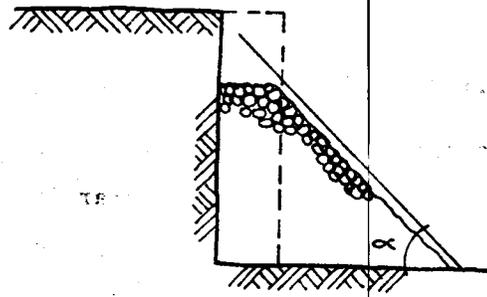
El ángulo  $\alpha$  debe ser  $45^\circ$ , si es mayor falta explosivo y si es menor sobran explosivos; muchas proyecciones también indican exceso de explosivos.
